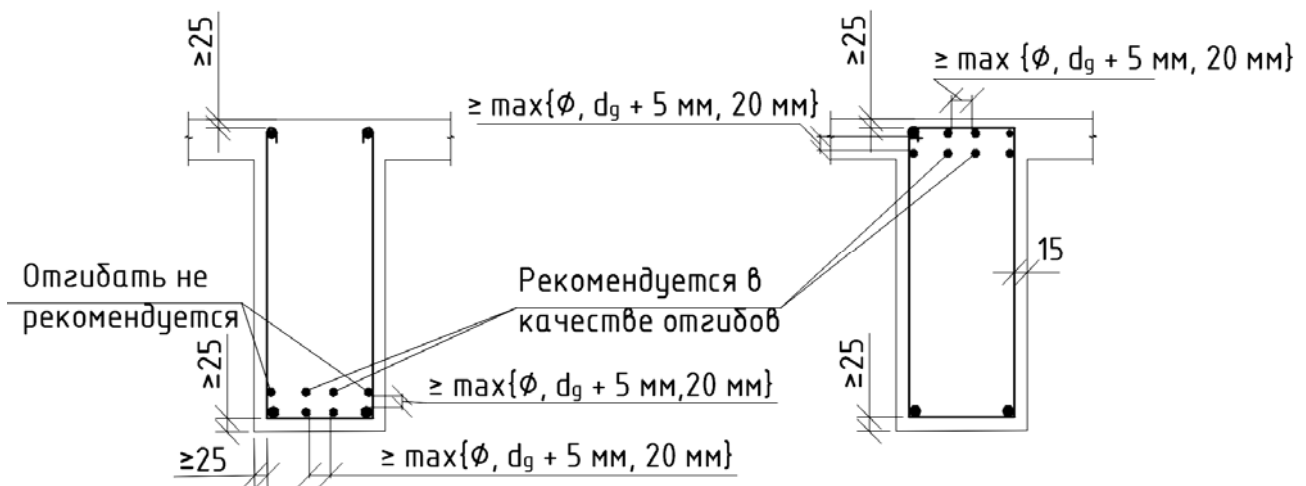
Расположение продольной арматуры в поперечном сечении балки
